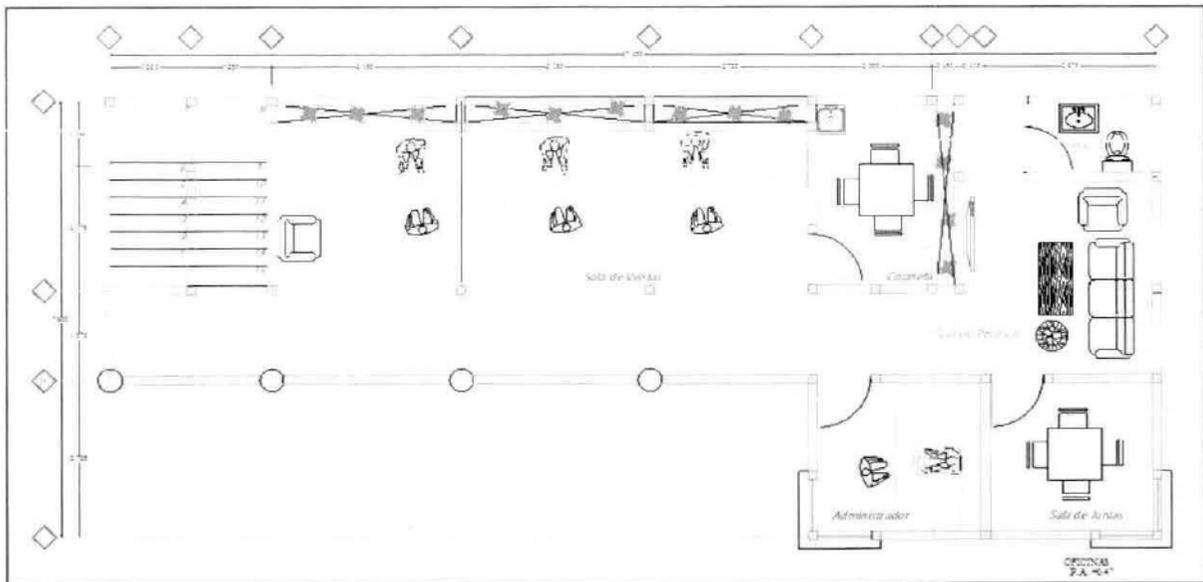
Área de Oficinas Planta Baja y Planta Alta
